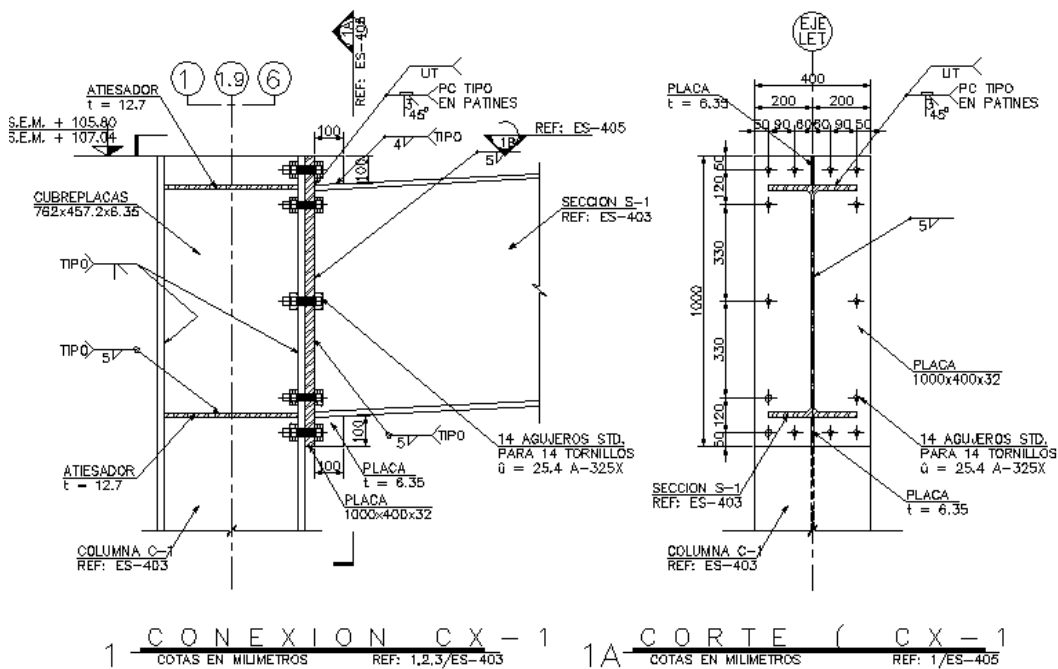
Conexión propuesta por el despacho Alonso y Asociados Proyecto Estructural. Vista en Planta
